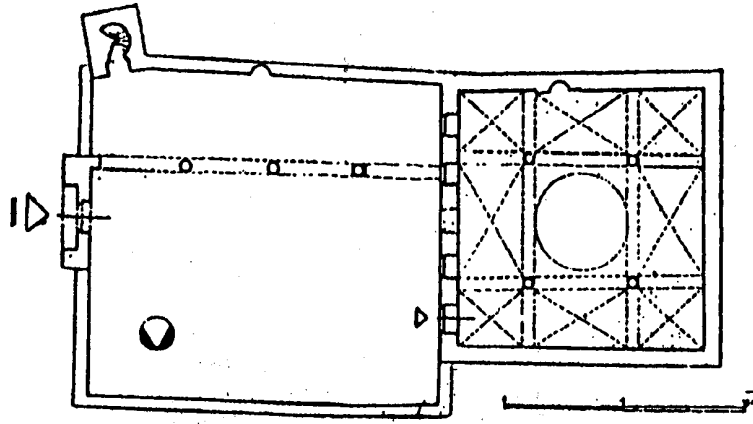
مسقط أفقي لجامع الفاتح الجديد بإستانبول (عن : Gabriel)
